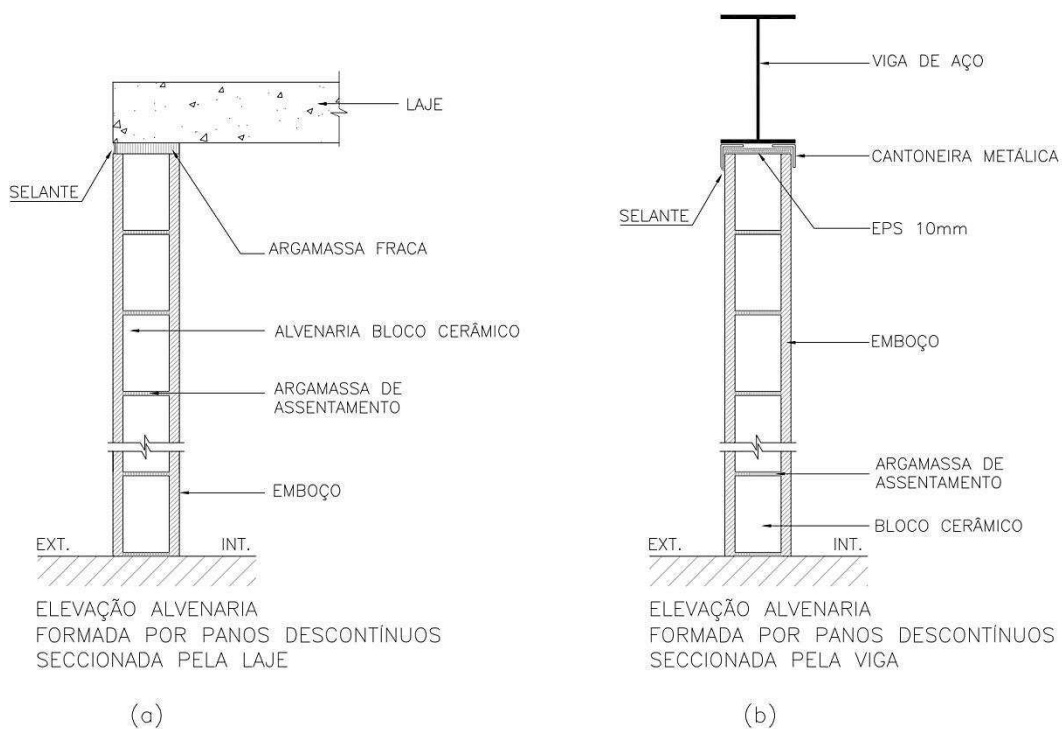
Alvenarias formada por panos descontínuos, seccionada pela laje (a) ou pela viga metálica (b).
